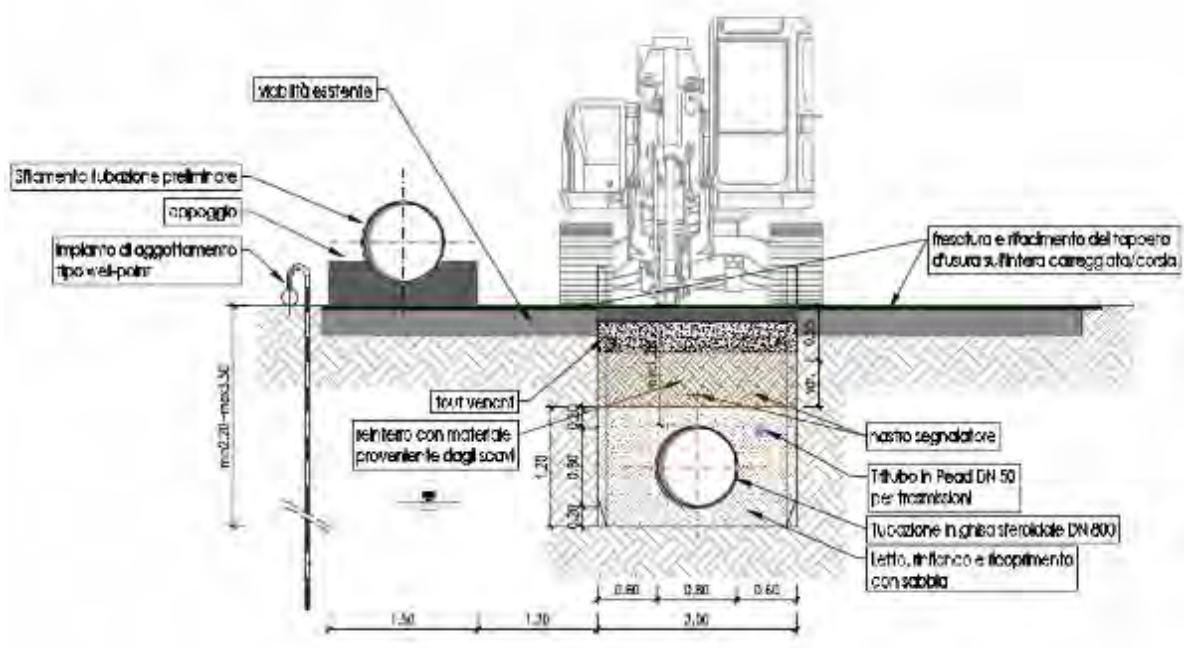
Sezione tipo 3 di scavo e di posa su strada comunale
